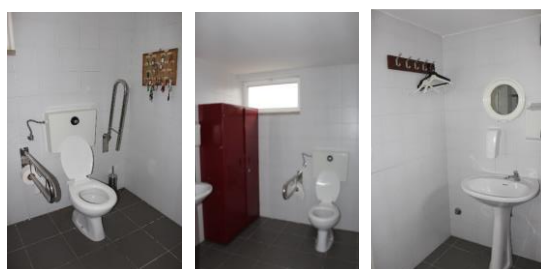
e 10 - Antecâmara (Pavilhão A)
